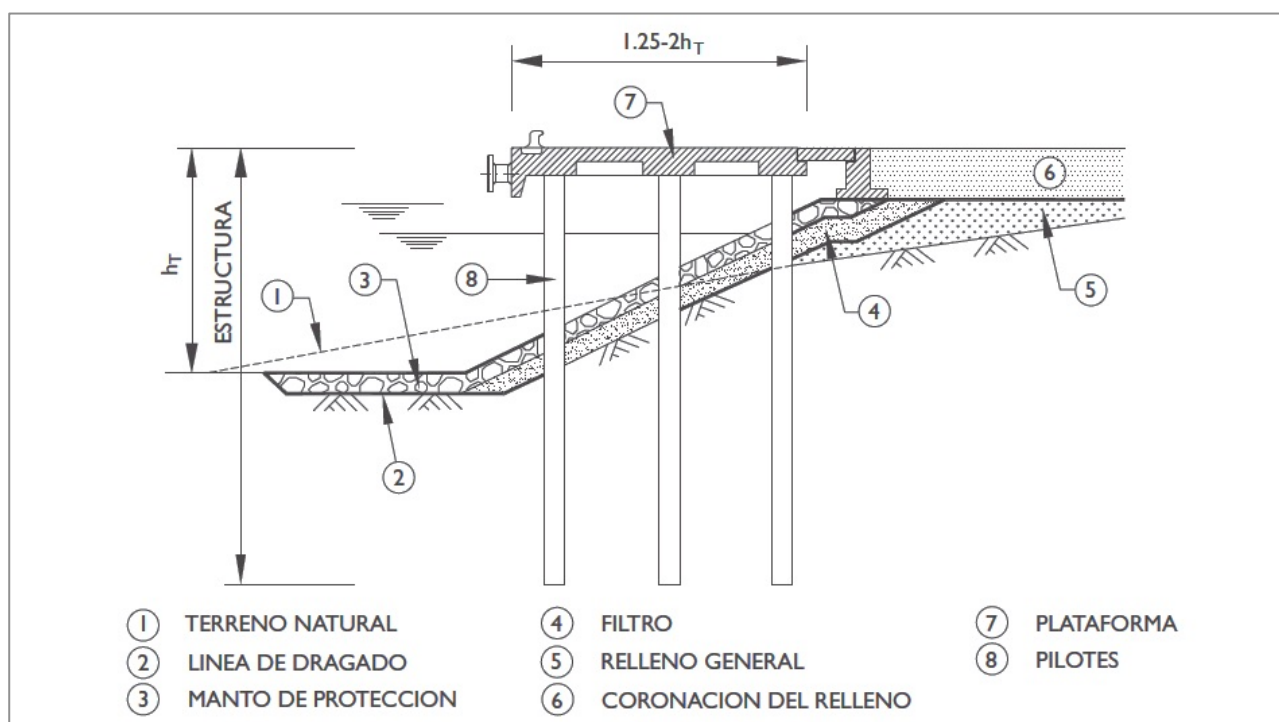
Muelle de plataforma sobre pilotes Sección tipo
